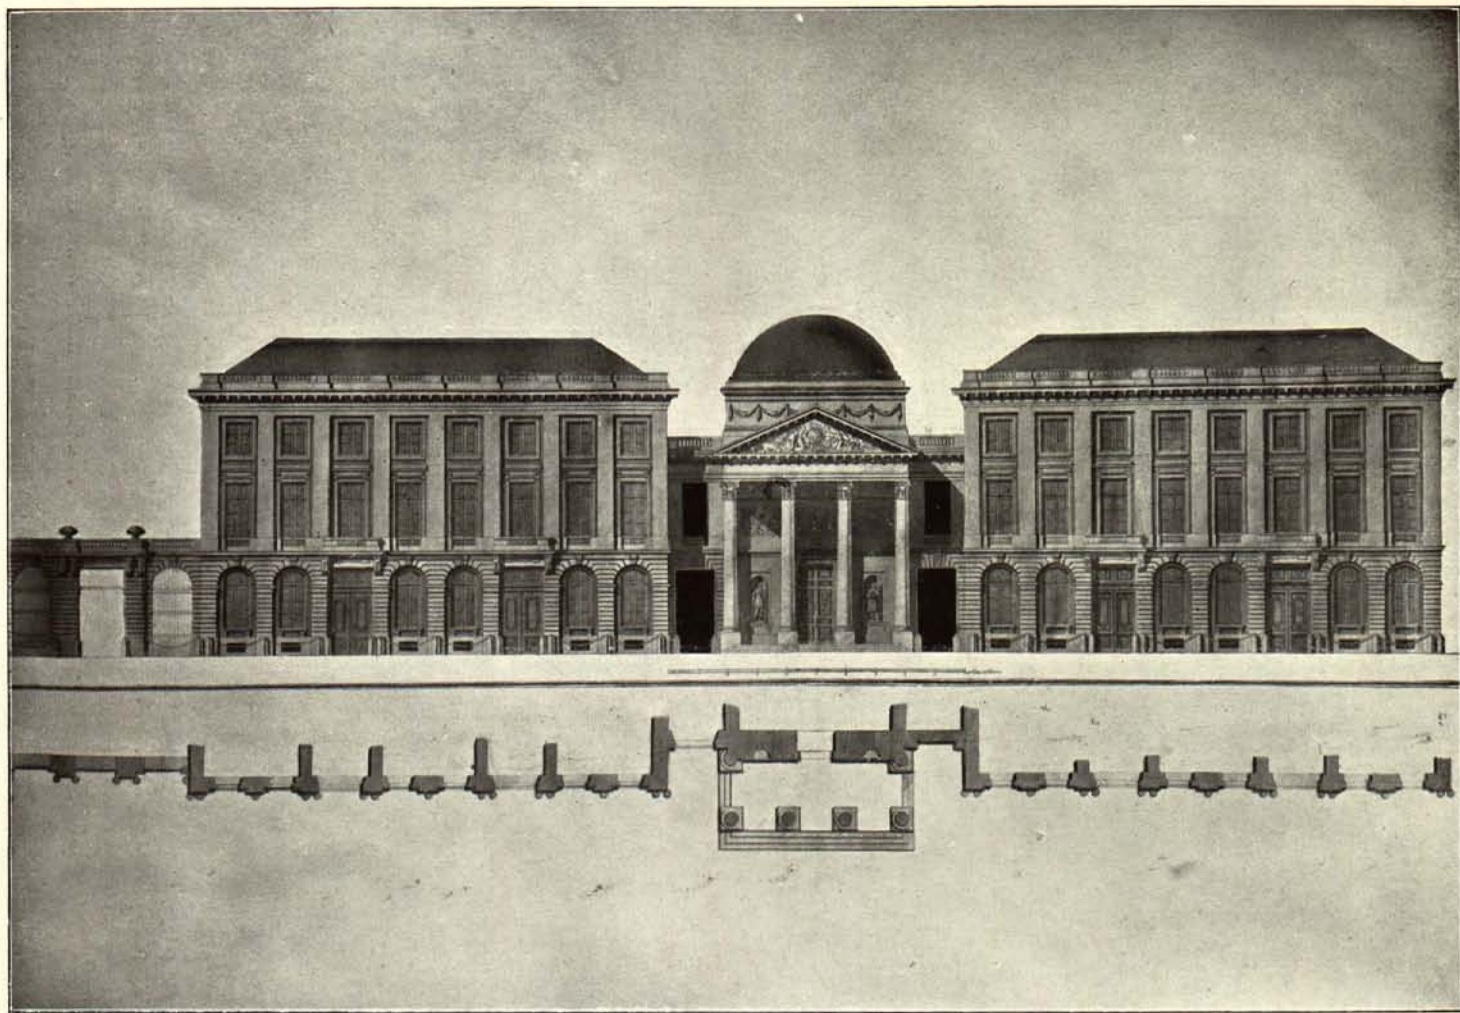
Extrait du plan général de la place Royale, par l'architecte Barré, de Paris. Juillet-août 1775.
